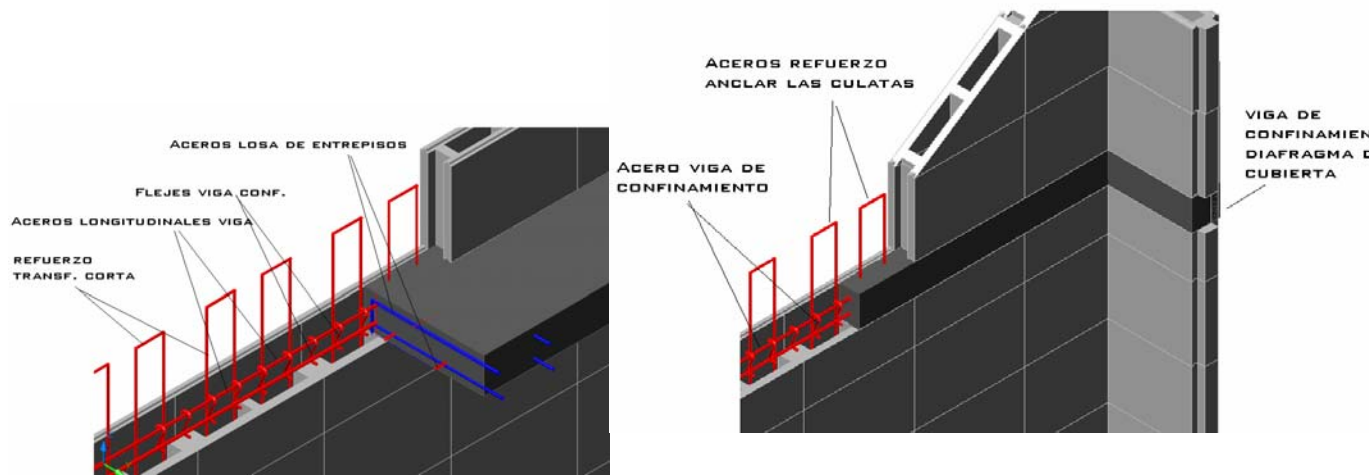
VIGAS DE ENTREPISO Y TECHO GRUPO A ZAS.
